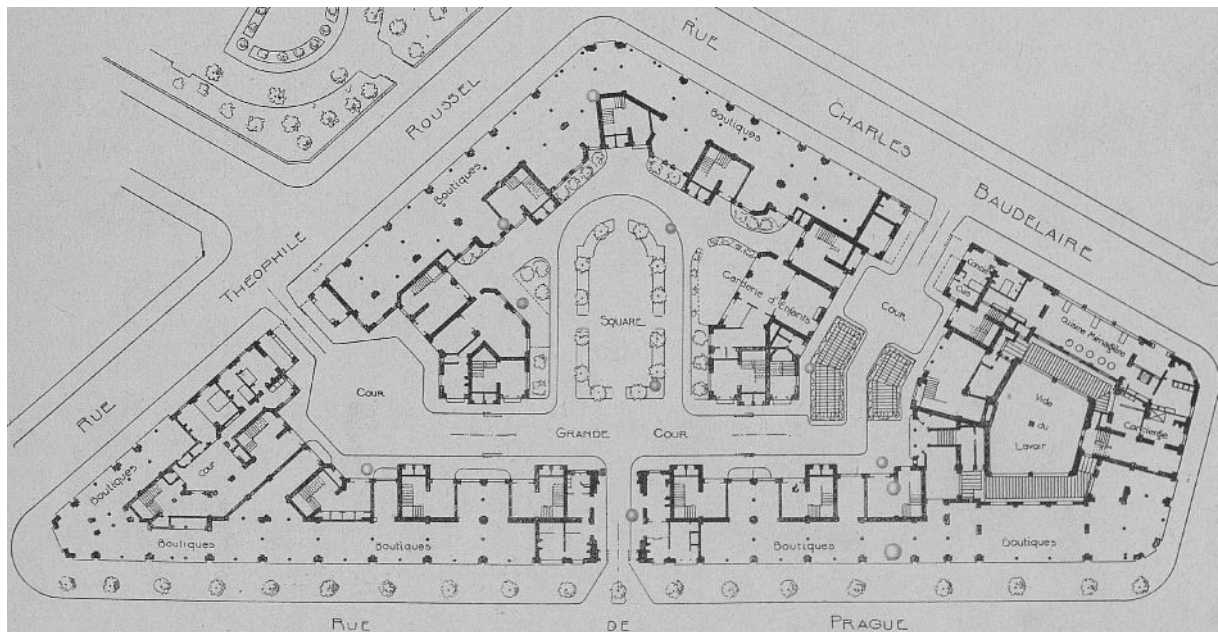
La fondation Rothschild, Rue de Prague 12ème, plan du rez-de-chaussée, in *La construction moderne*, 1911, supplément au n° 1, pl. 1.
